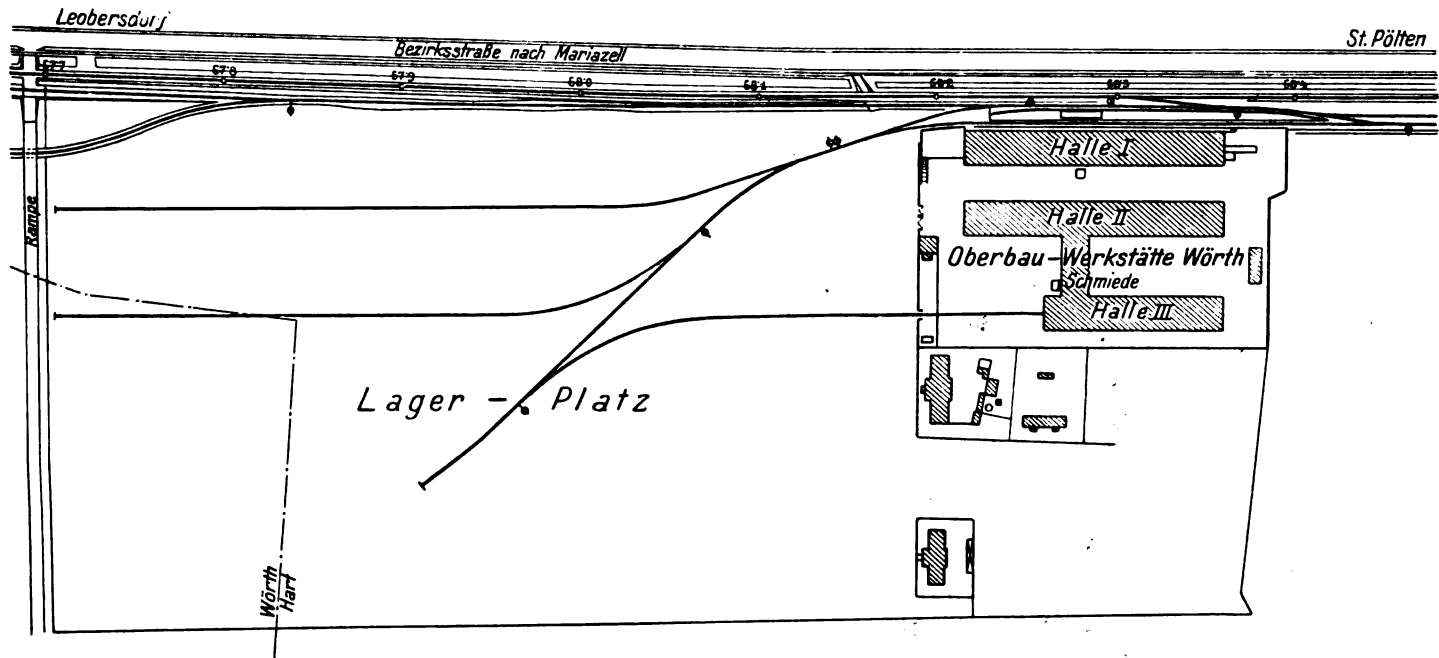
Lageplan des Oberbaulagers und der Werkstätte Wörth.
